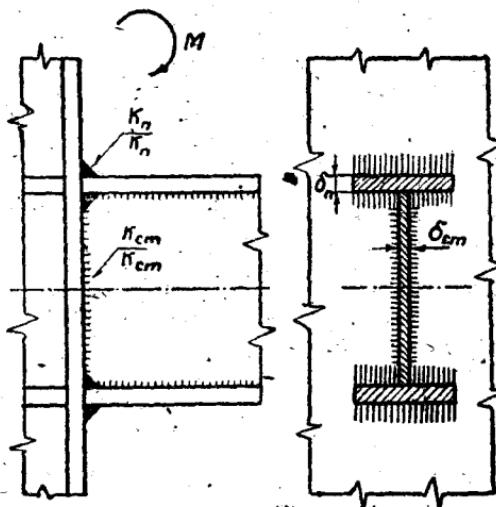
用角焊缝对头拼接的焊接接头計算用之示意图
